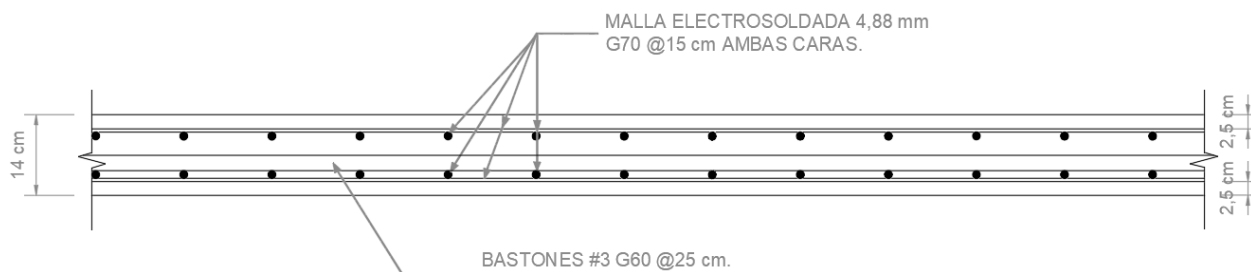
Sección transversal del eje longitudinal de la losa vista en campo (bastones para momentos positivos)
